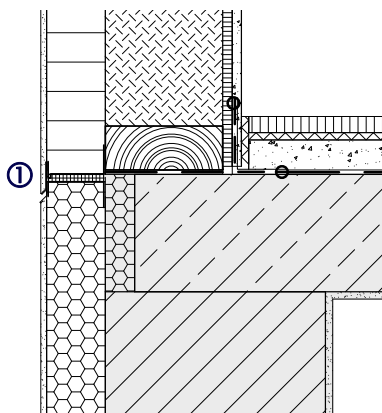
Gebäude mit Betondecke und durchgängigem Wärmedämm-Verbundsystem
